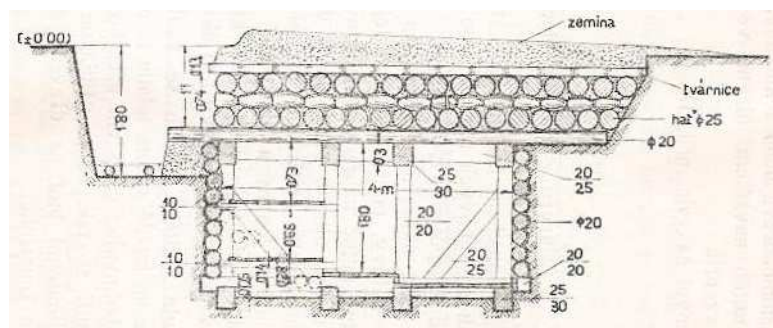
Střední povrchový úkryt se třemi stropními vrstvami
